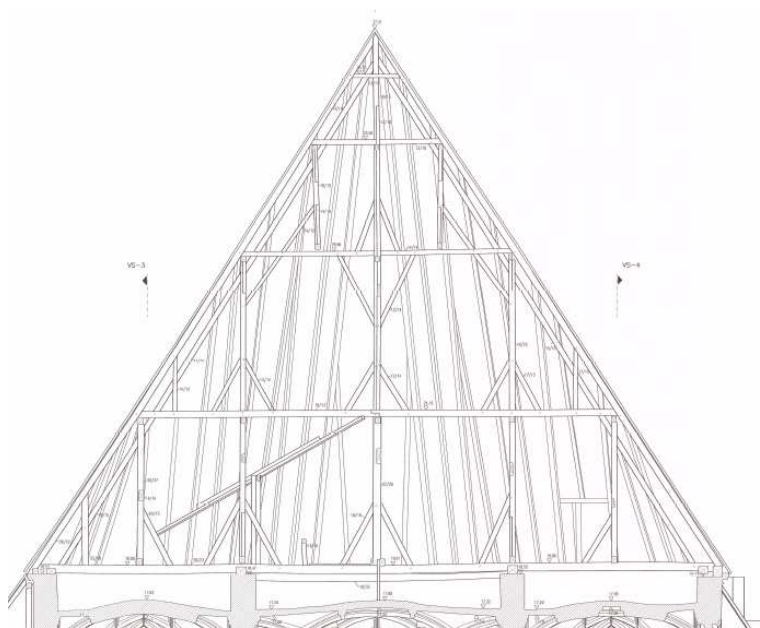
Steyr, Stadtpfarrkirche, Querschnitt Dachstuhl; viergeschossiger Kehlbalkendachstuhl
